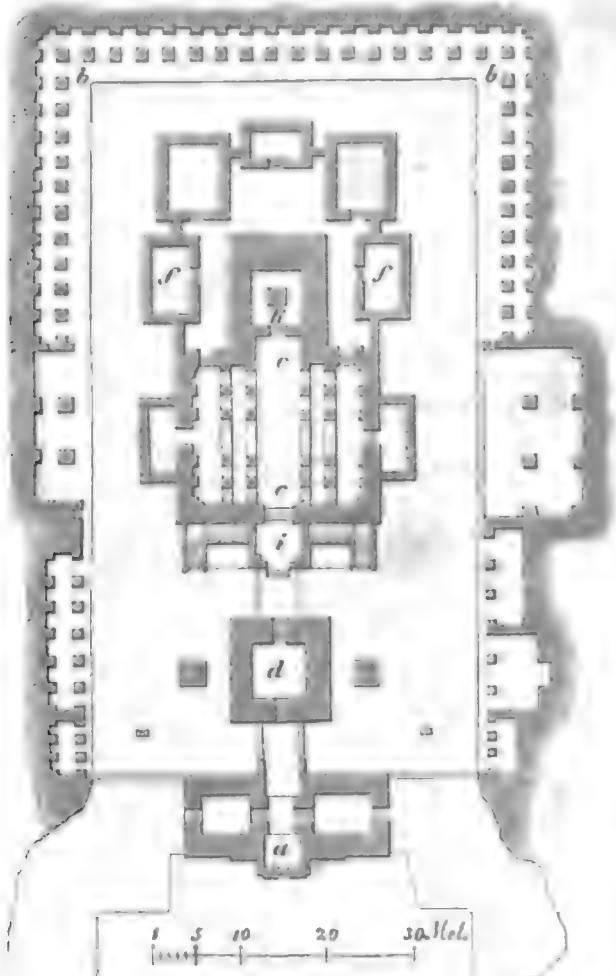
Grundriss der Kerylas in Ellora.
